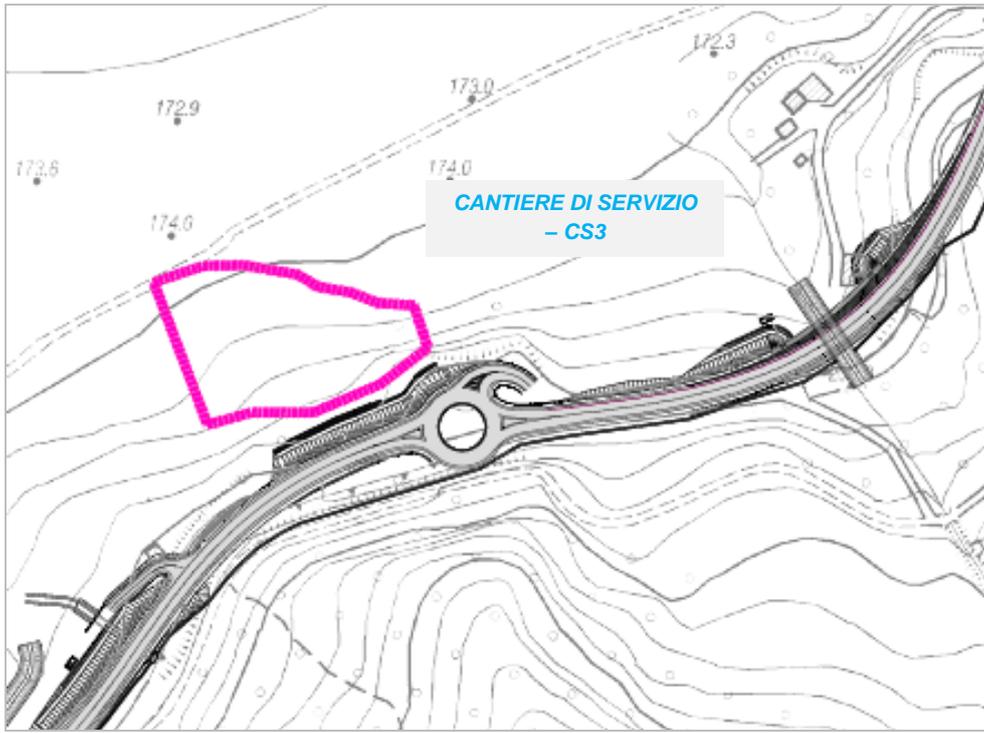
PLANIMETRIA CANTIERE DI SERVIZIO CS3
